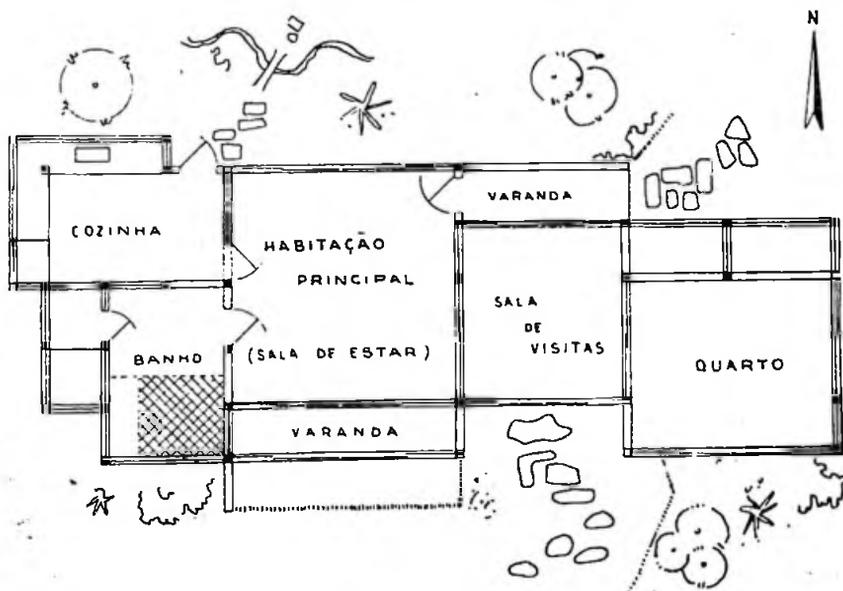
PLANTA DE UMA CASA JAPONESA
